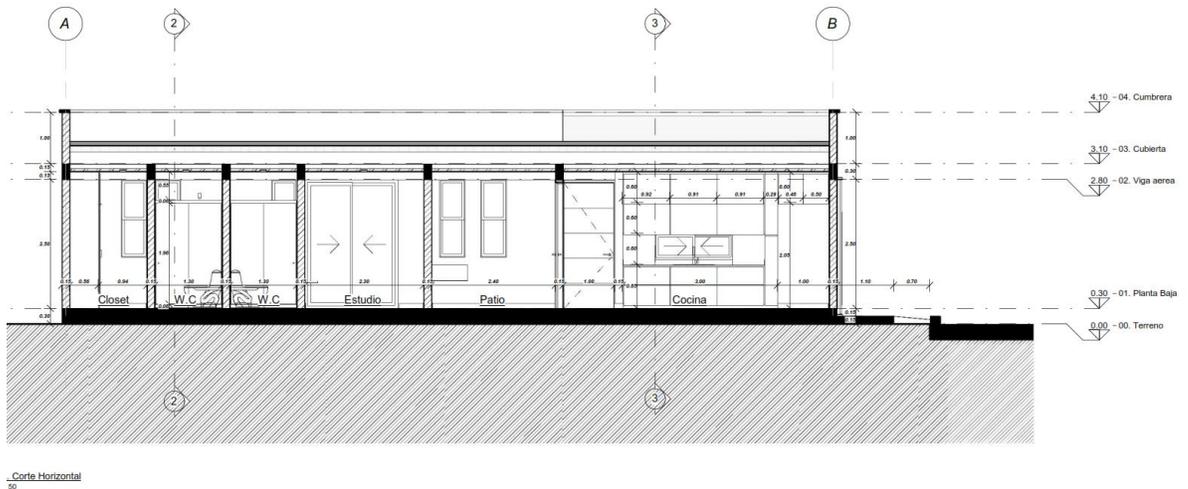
Plano de corte transversal – Diseño casa Montecarlo
